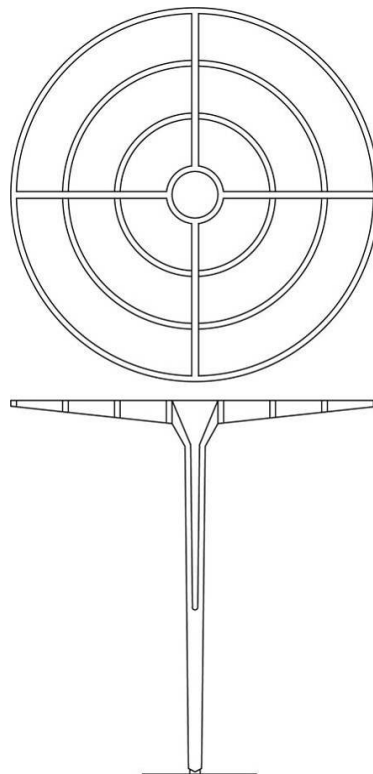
Planta y sección de una columna cortada para ver la formación del Petal.
